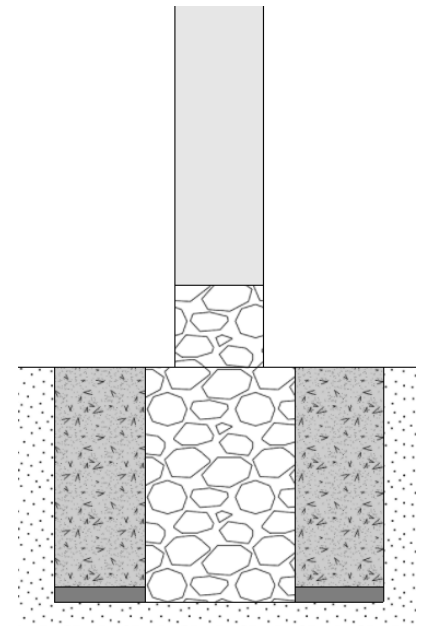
El tipo de llenado de la zanja será definido por especialistas, procurando enrasar con el nivel superior. Fuente: Elaboración propia.
